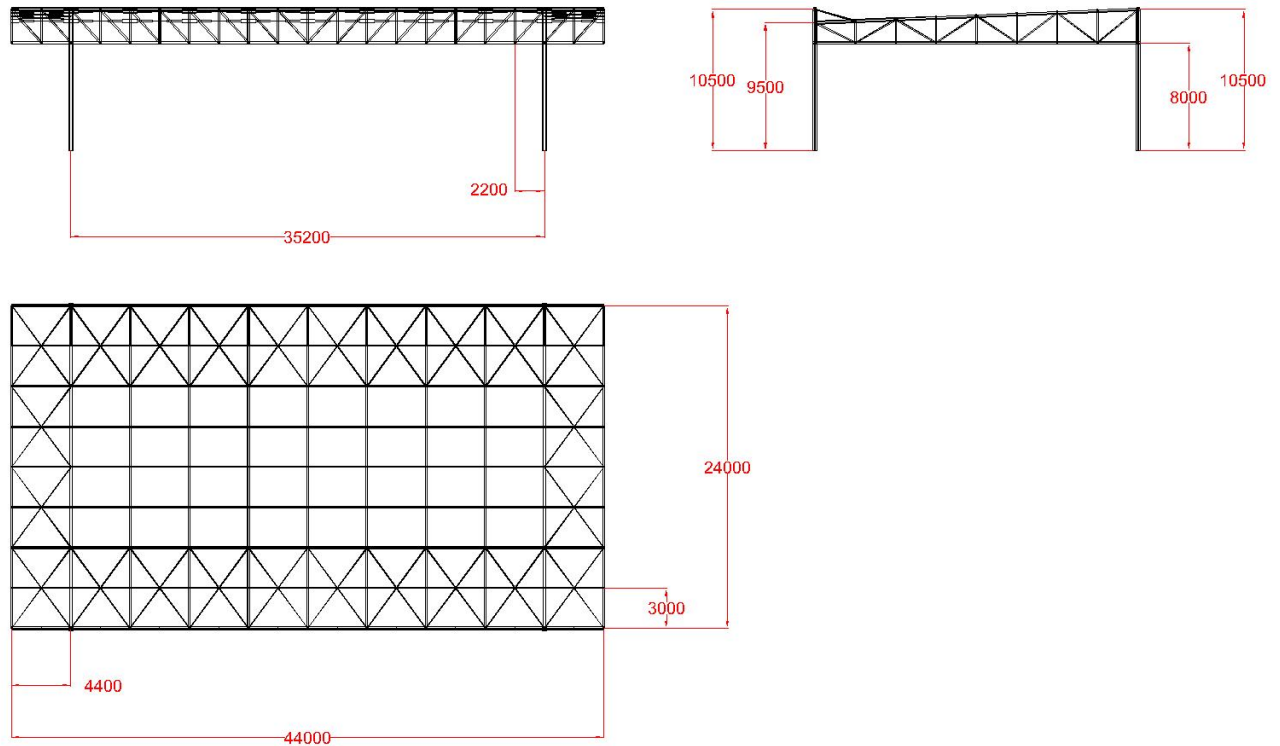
Vistes alçat, planta i perfil amb dimensions generals
